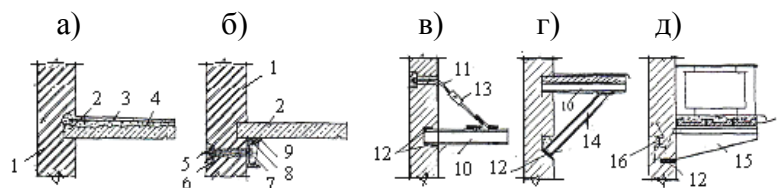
Реконструкция балконов с сохранением расчетной схемы балконной плиты (а,б) и с заменой консольной балконной плиты на балочную (в,г,д):
